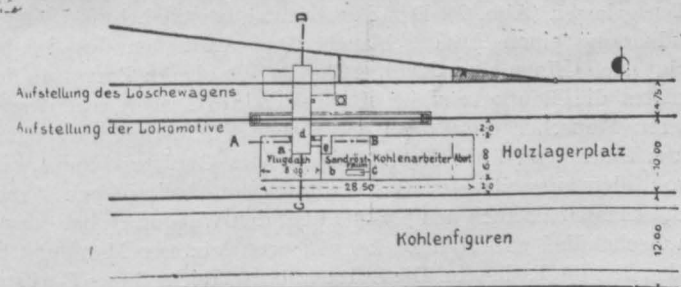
Plan der mechanischen Besandungs- und Ascheabfuhranlage.
